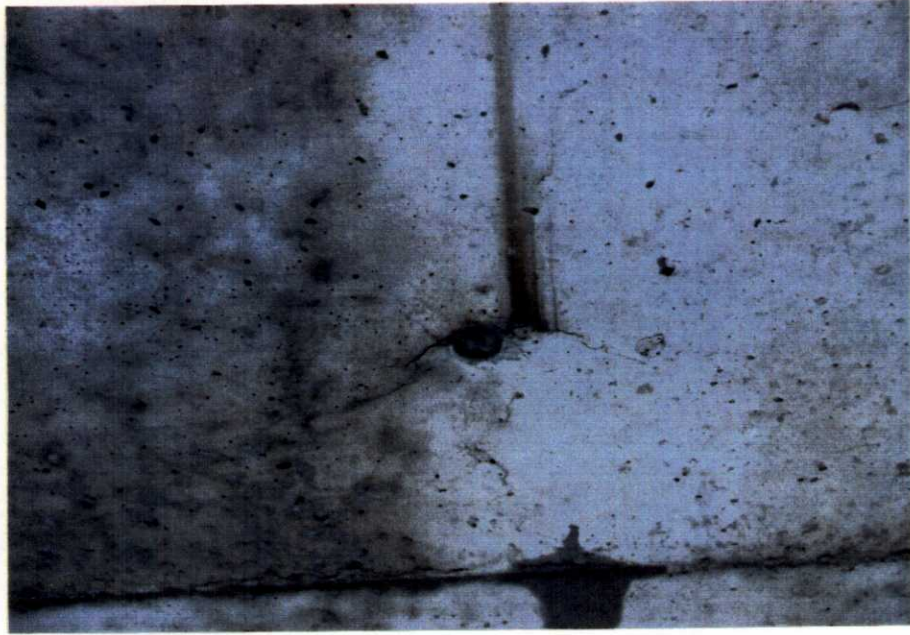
施工時ひびわれの例 (海岸擁壁・橋脚)
